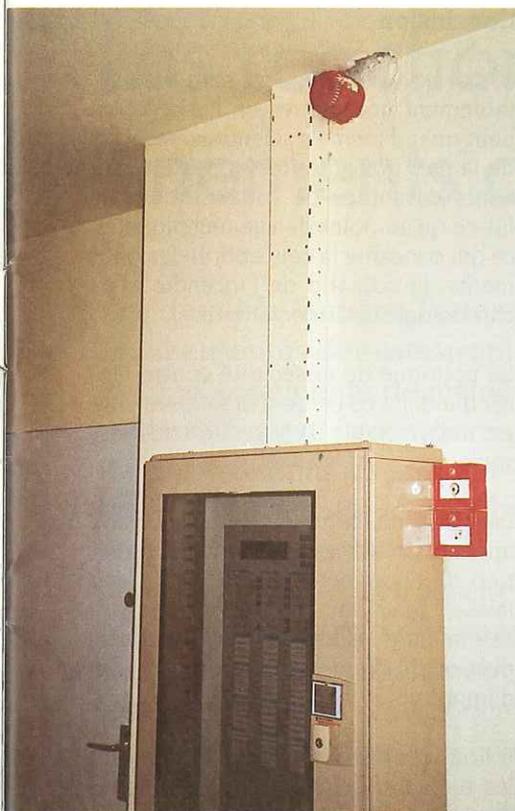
Le central de détection avec les boutons-poussoirs et les sirènes d'alarme électronique est situé au rez-de-chaussée.
